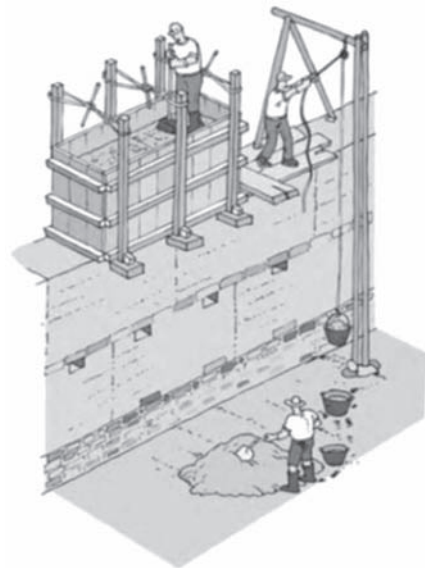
Sistema constructivo de tapia en muros, empleado originalmente en la hacienda de Santa Teresa Ixtafiyuca. Fuente: *Manual para la Rehabilitación de viviendas construidas en adobe y tapia pisada*. 1999.
